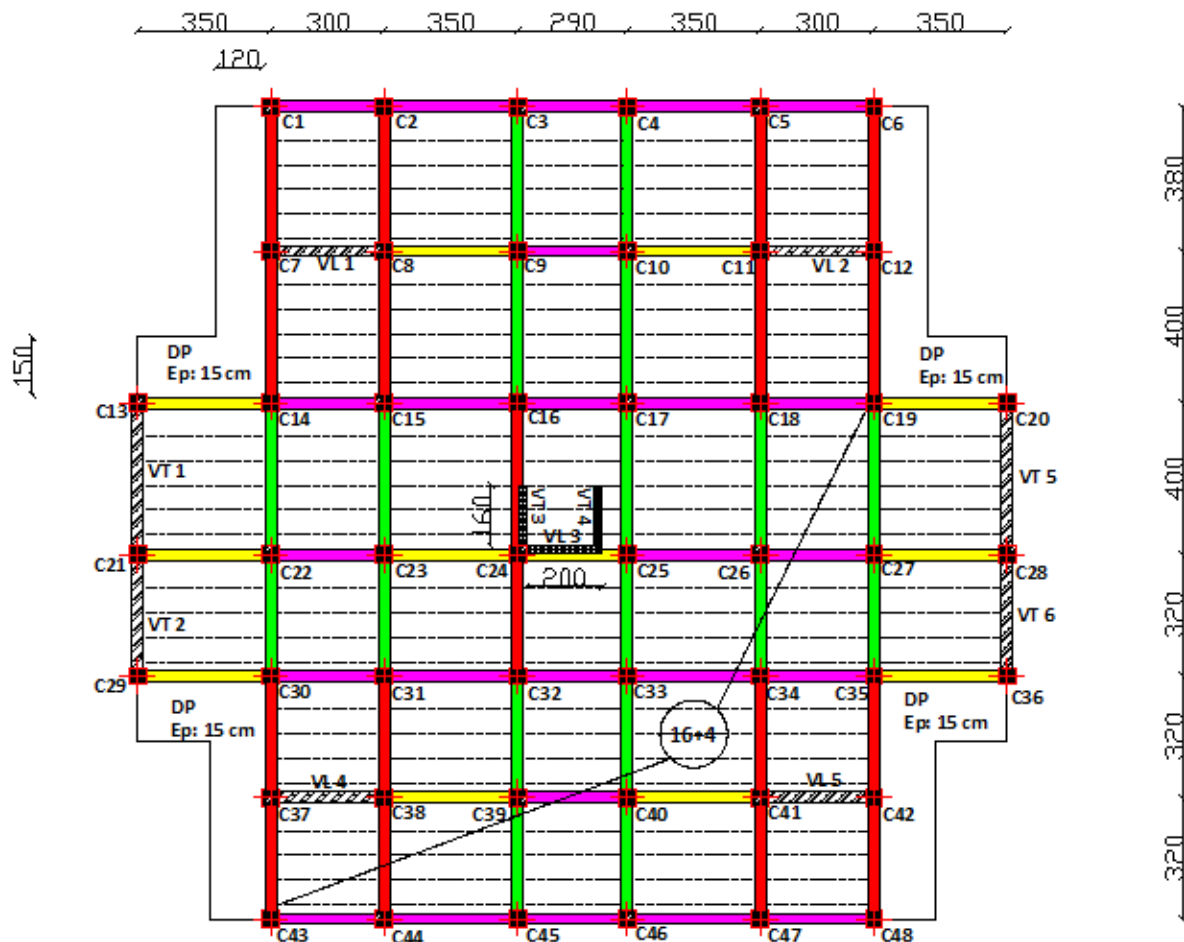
Figure montrant le groupe des poutres pour le ferrailage
